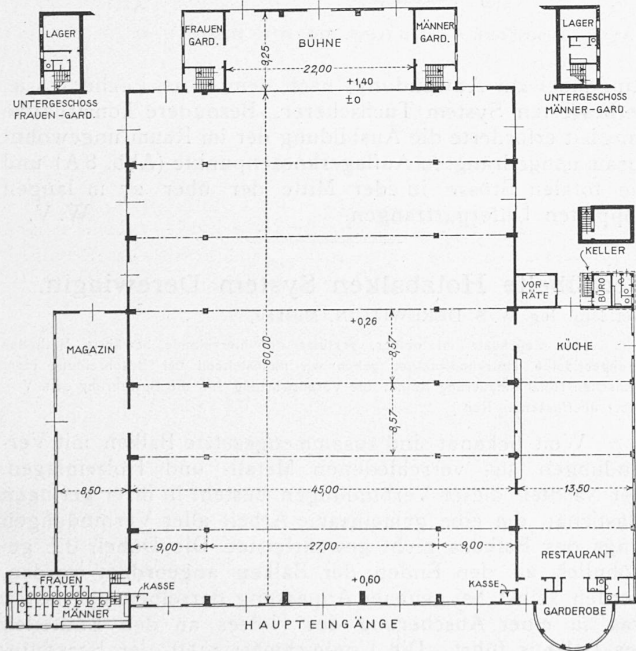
Grundriss der Markt- und Ausstellungshalle in Chur. — 1 : 800.
